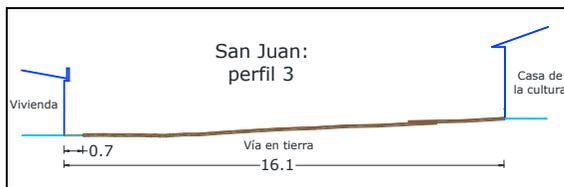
Perfil 3 Vía Local en adoquín en concreto Centro Poblado san Juan
